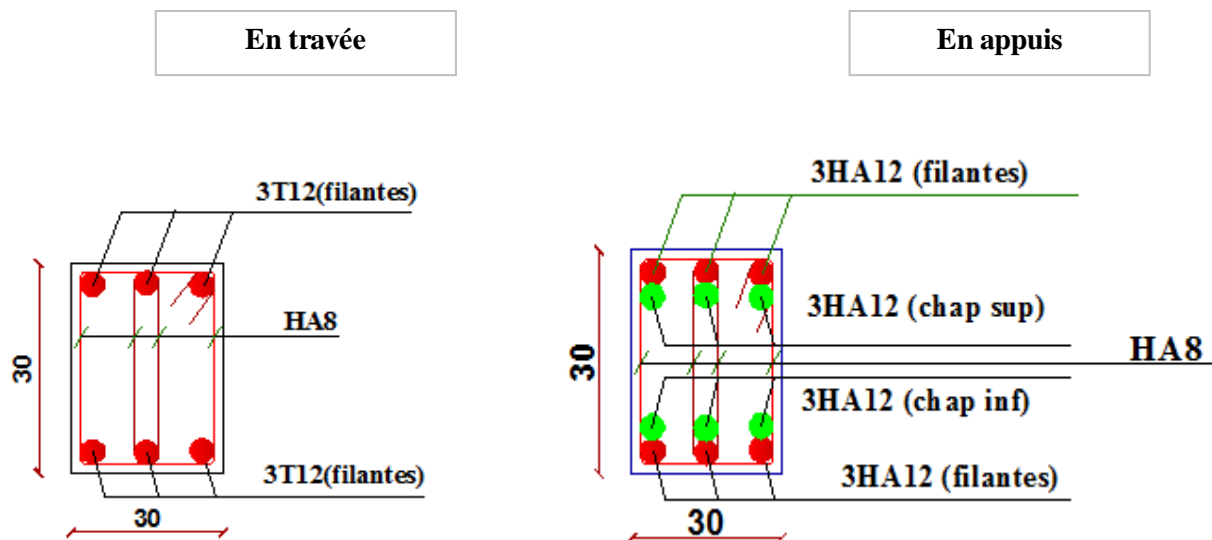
Ferrailage des poutres secondaires de la structure mixte
